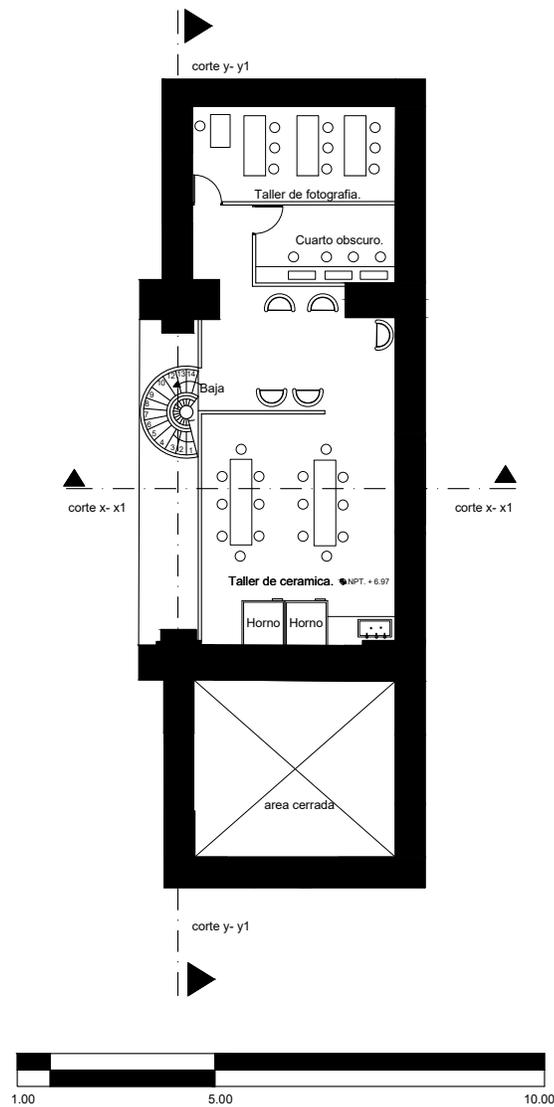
Planta del tercer nivel del edificio de St. Domingo.
